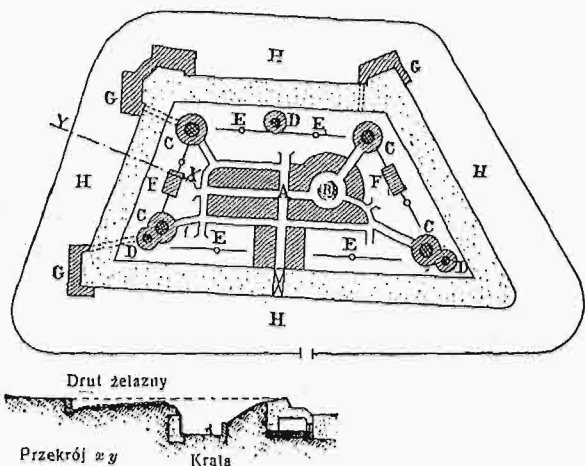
Plan i przekrój kazamaty typu zastosowanego w Bourges.
